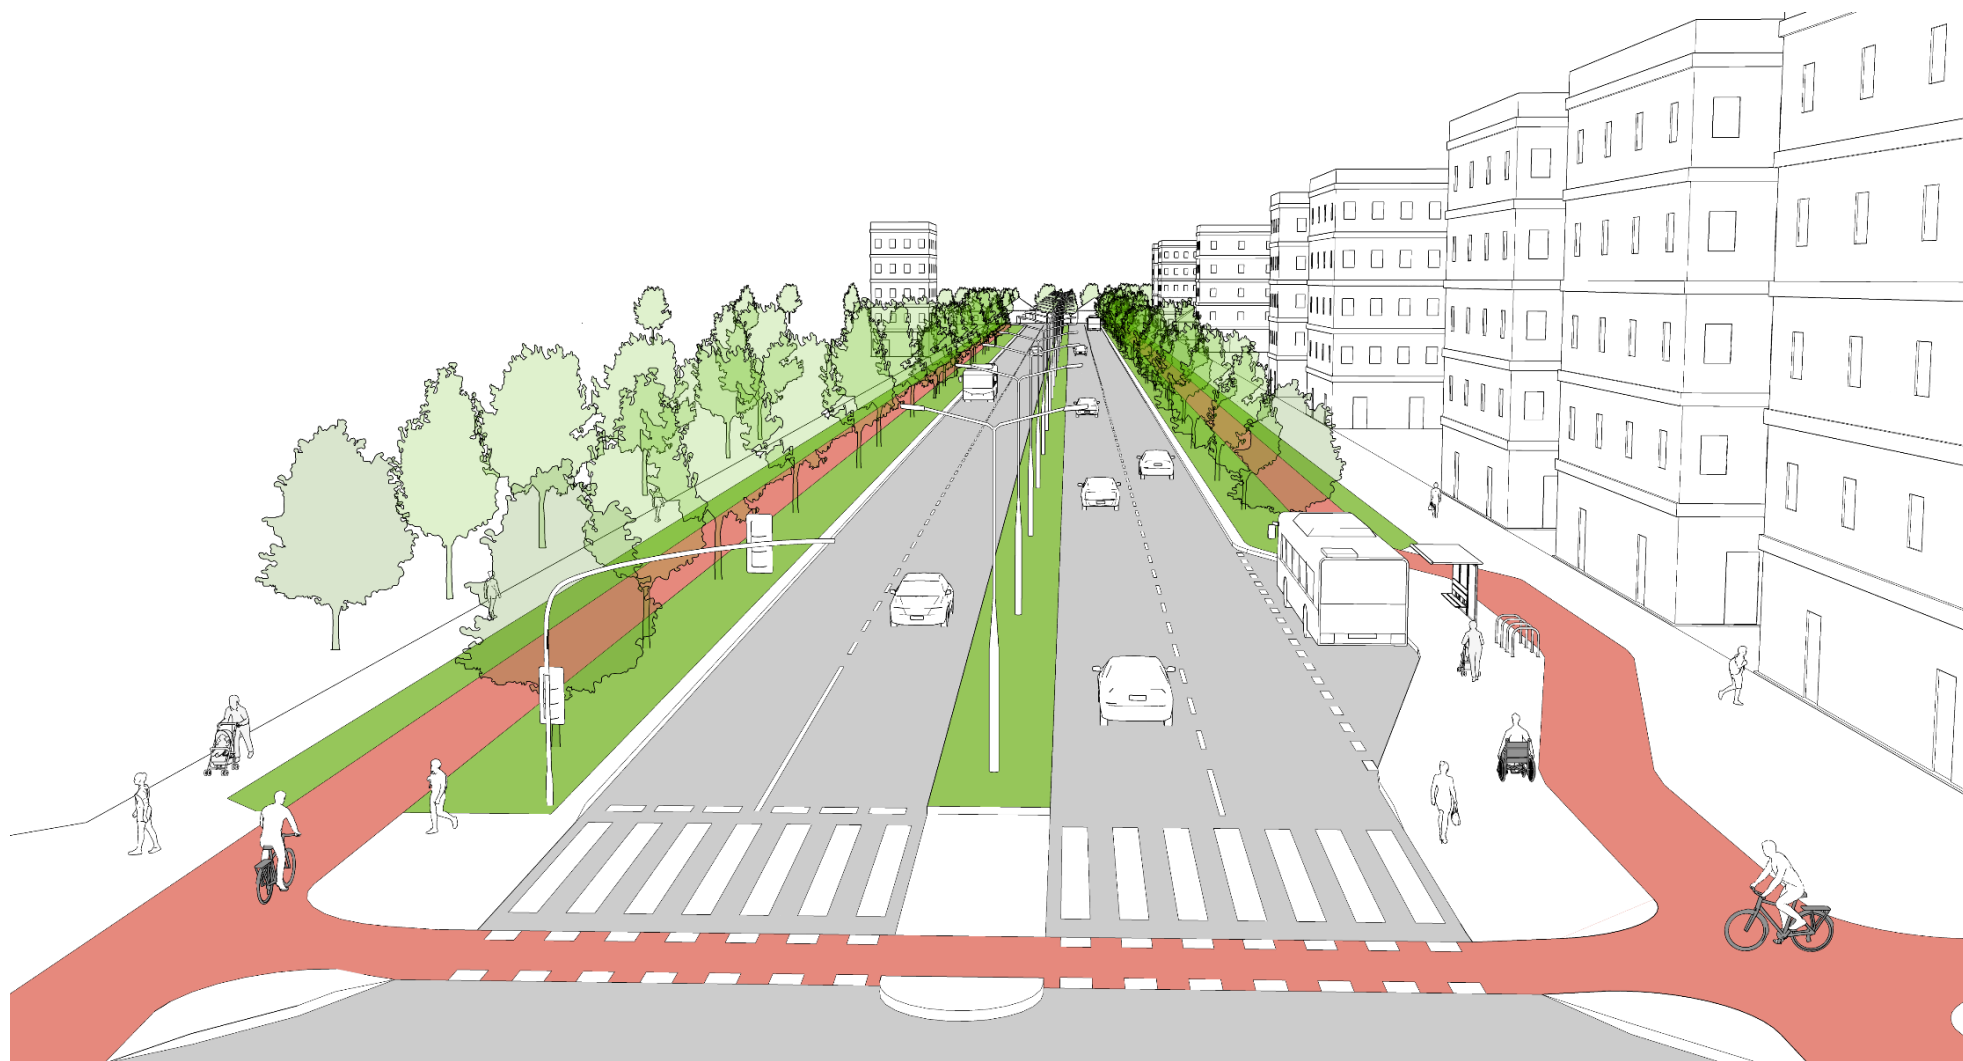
Przykładowa wizualizacja przekroju podstawowego dwukierunkowego G1/2 (typ G2)
